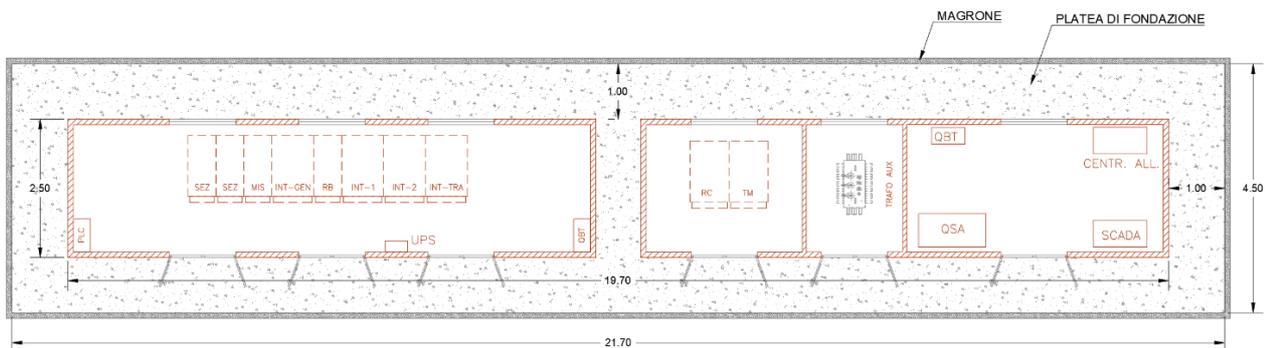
Sezione C della platea di Fondazione della Power Station
